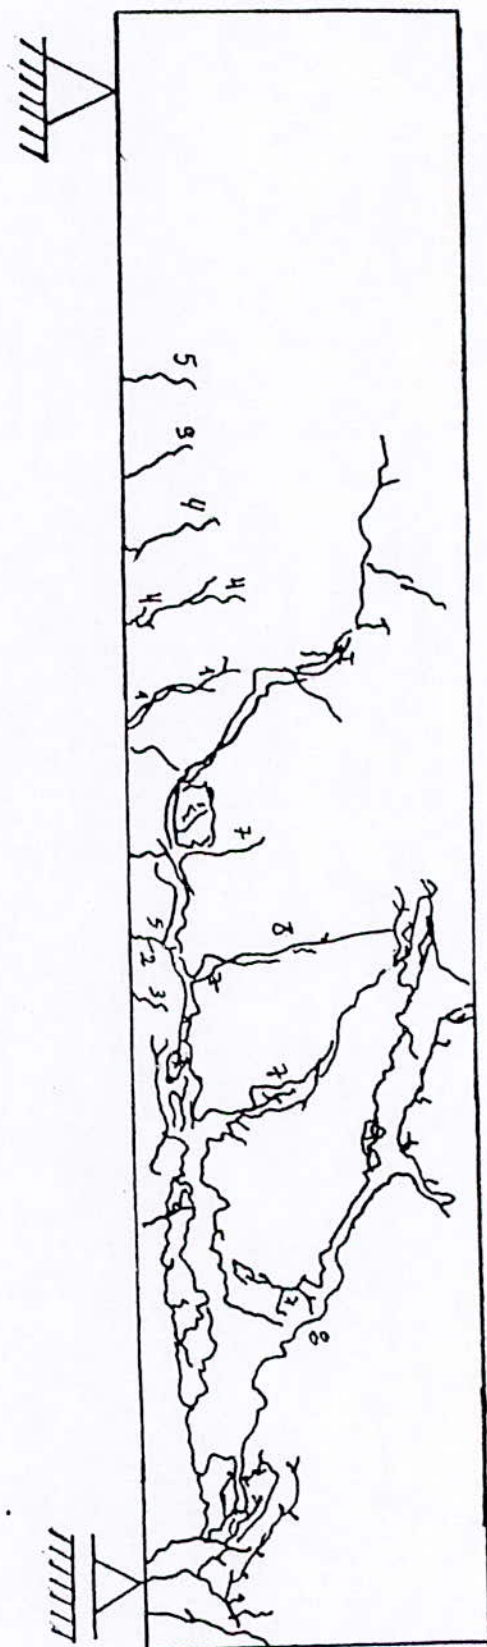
Schéma de fissuration de la poutre T2A
